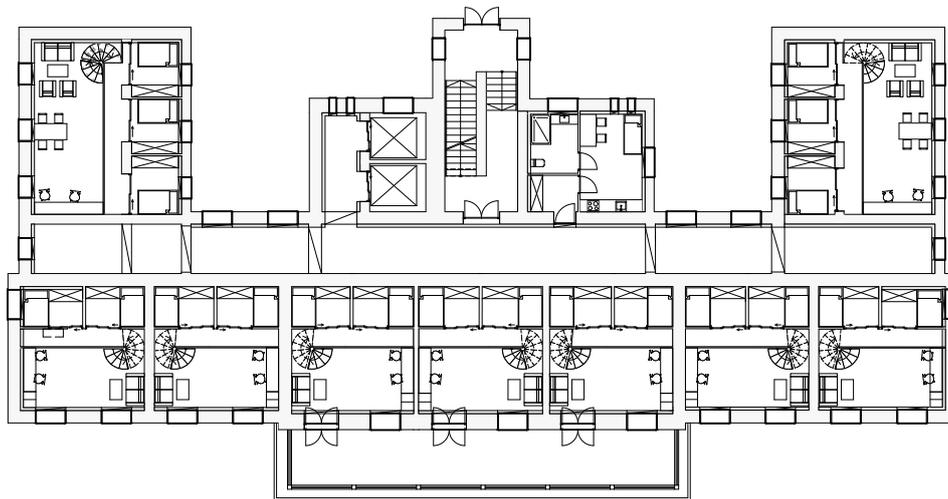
Entwurf Erdgeschoß - Zwischengeschoß Studentenzimmer
